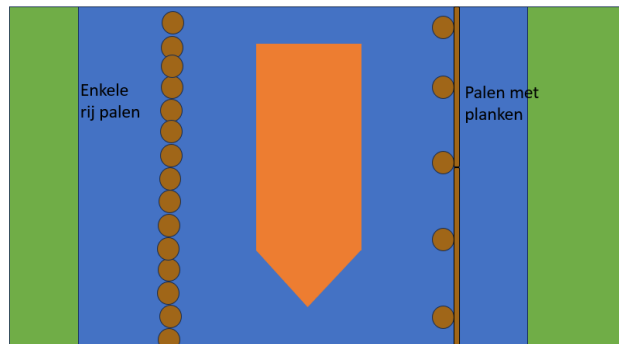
Beschoeiing bestaande uit palen en planken
